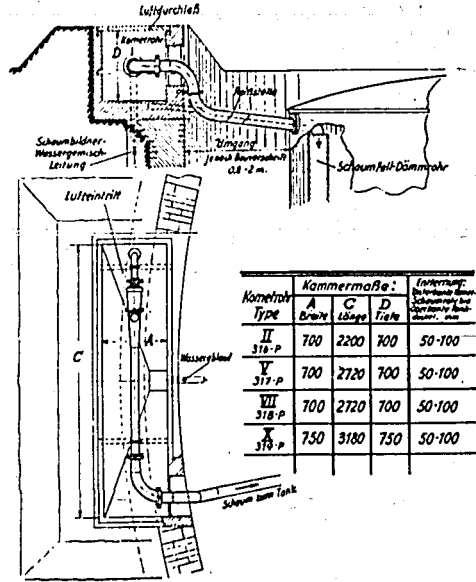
Liegender Einbau des Tankkomertrohres in Splitterschubbetonkammer — Montage horizontale du tube comerté pour réservoir. Installation en chambre bétonnée pare-éclats — Horizontal installation of the tank comert pipe in a splinter-proof concrete chamber
